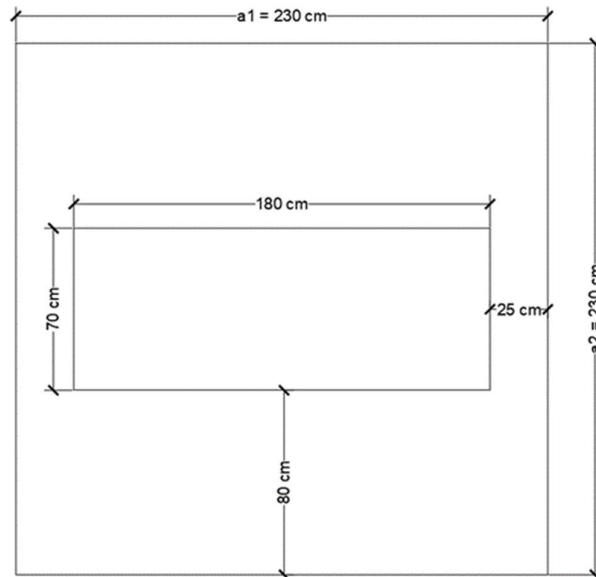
| Medidas adoptadas para la zapata. Fuente: Elaboración propia.
